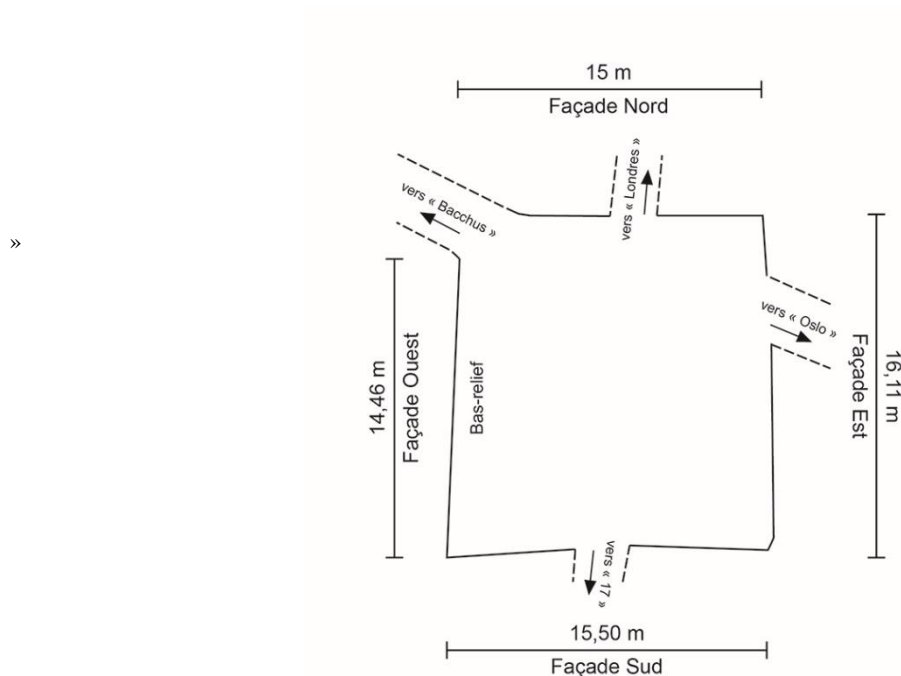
Plan au sol de la cave 16 dite « Silène »
